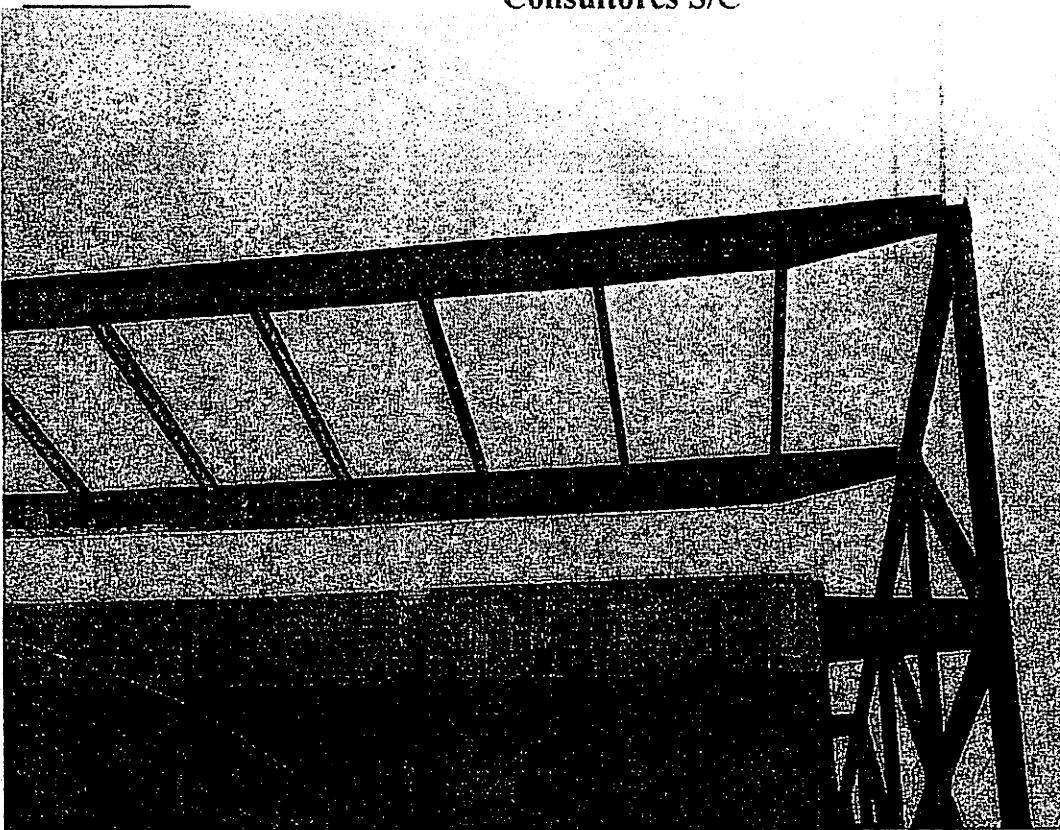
Vista da estrutura sobre o Teatro Iemanjá
